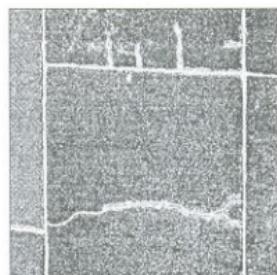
Дефекты панели до реконструкции фасада (трещина в наружном слое бетона)
